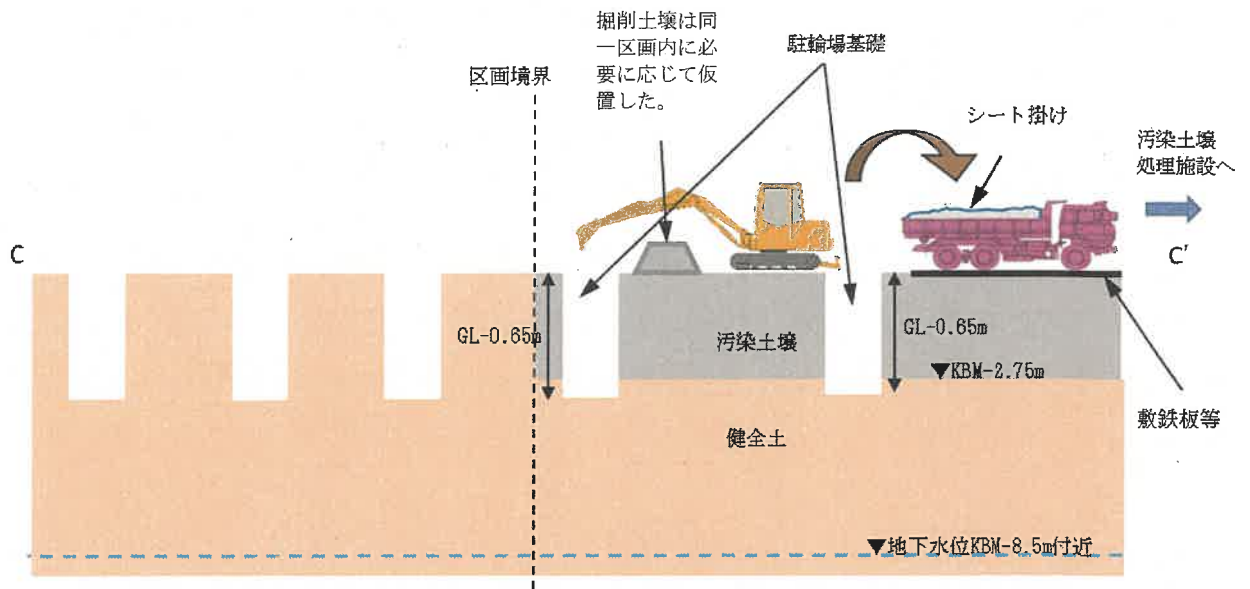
(3) 土地の形質の変更の施工方法を明らかにした断面図 (外構躯体工事)
